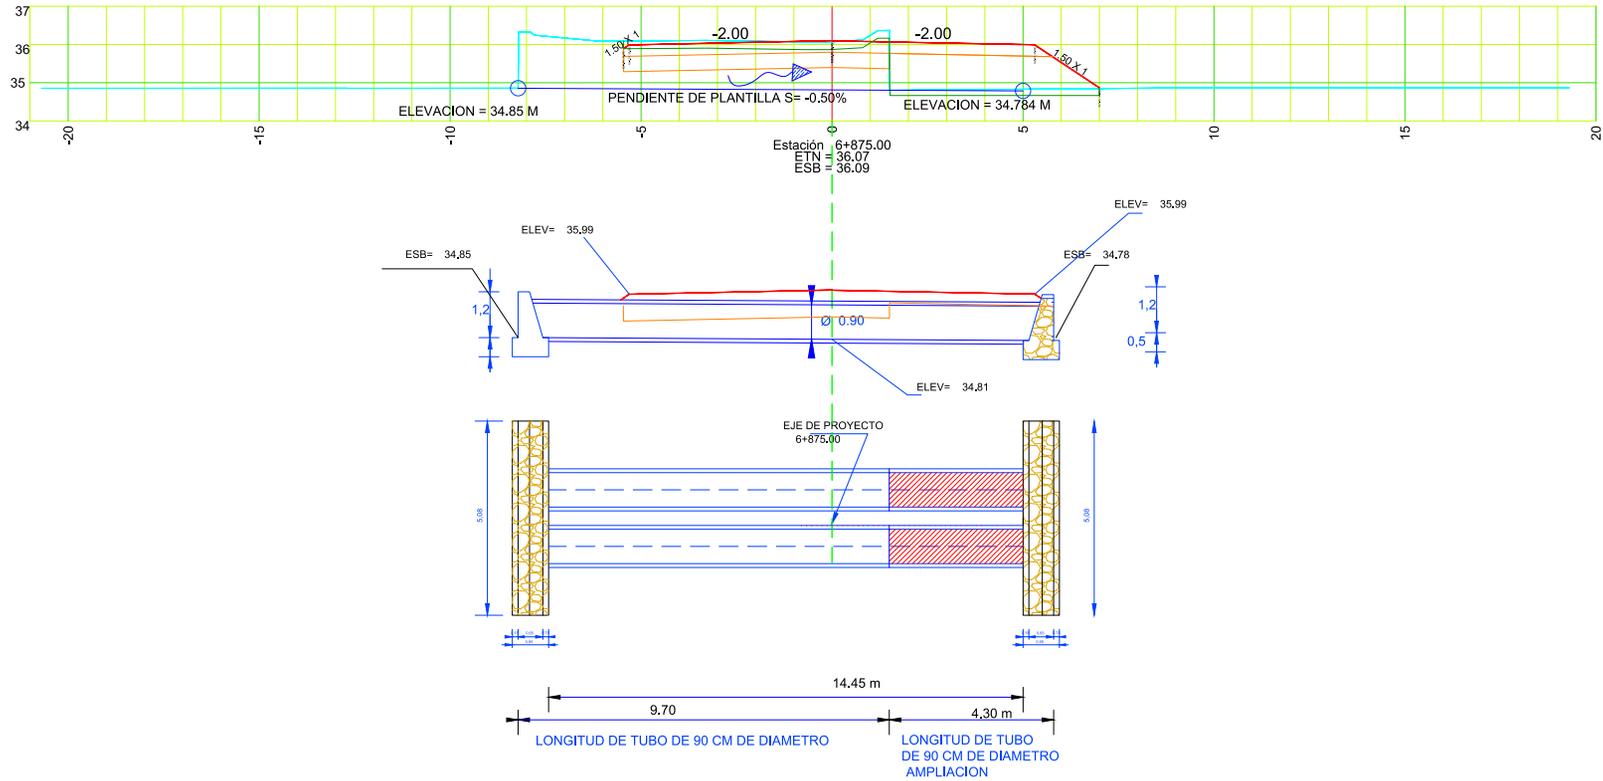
Sección en planta para la colocación de tres tubos de concreto
